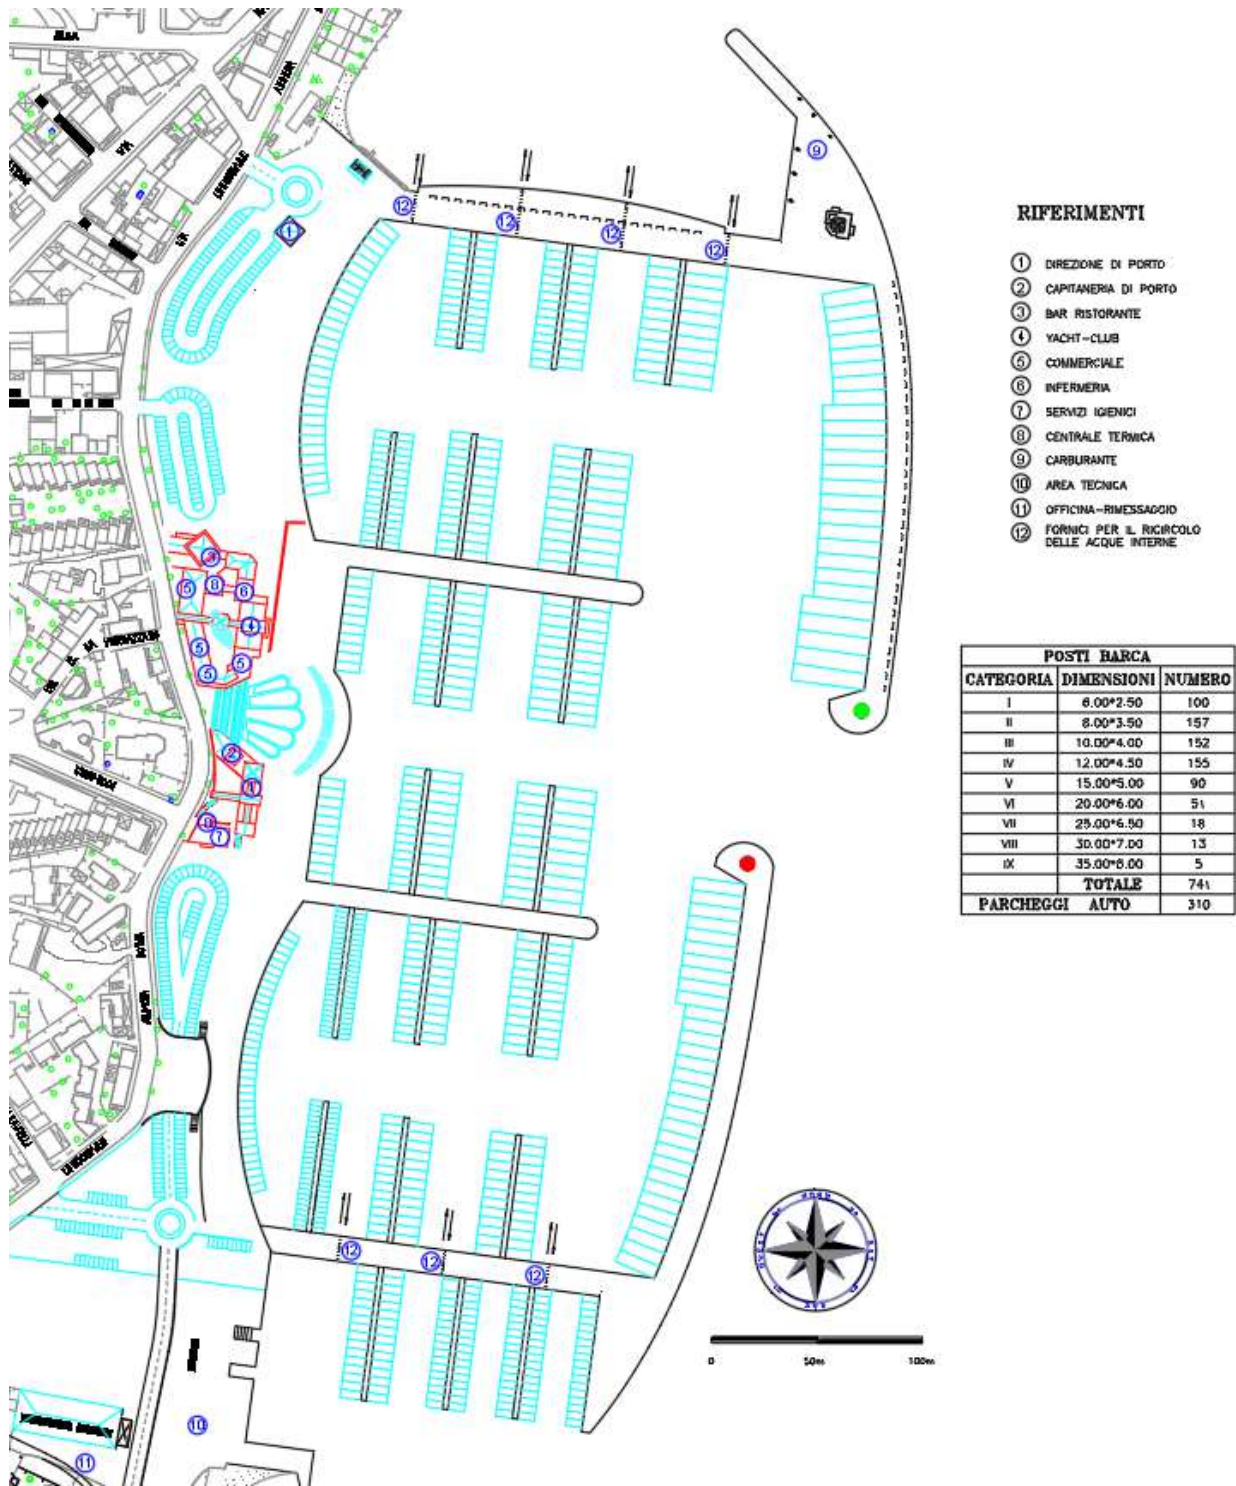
Progetto preliminare nel 2002, dal Servizio Porti ed Opere di Interesse Locale dell'Assessorato dei LL.PP. della Regione Autonoma della Sardegna
